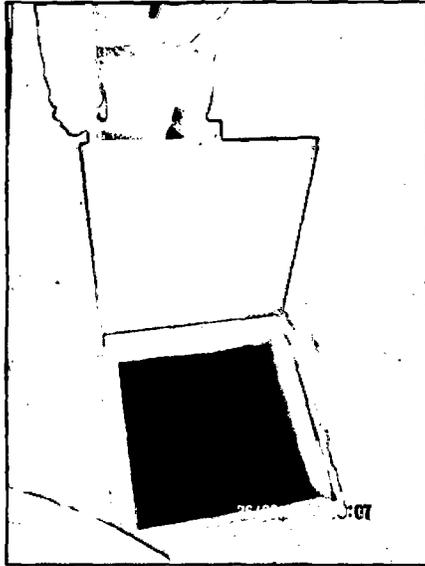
Tapa Sanitaria Metálica en mal estado
